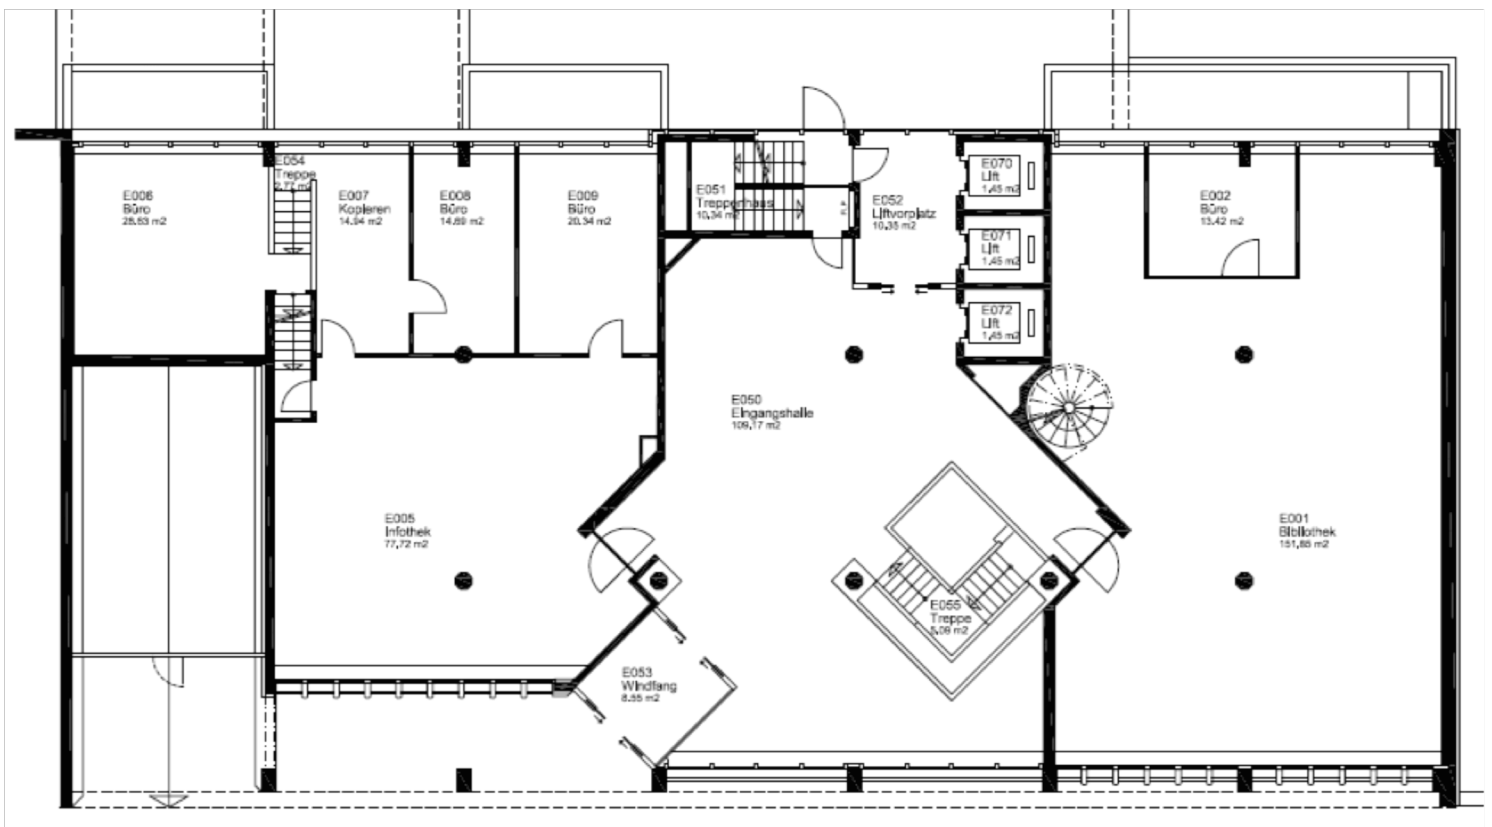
Grundriss des Erdgeschosses am Steinengraben 5
